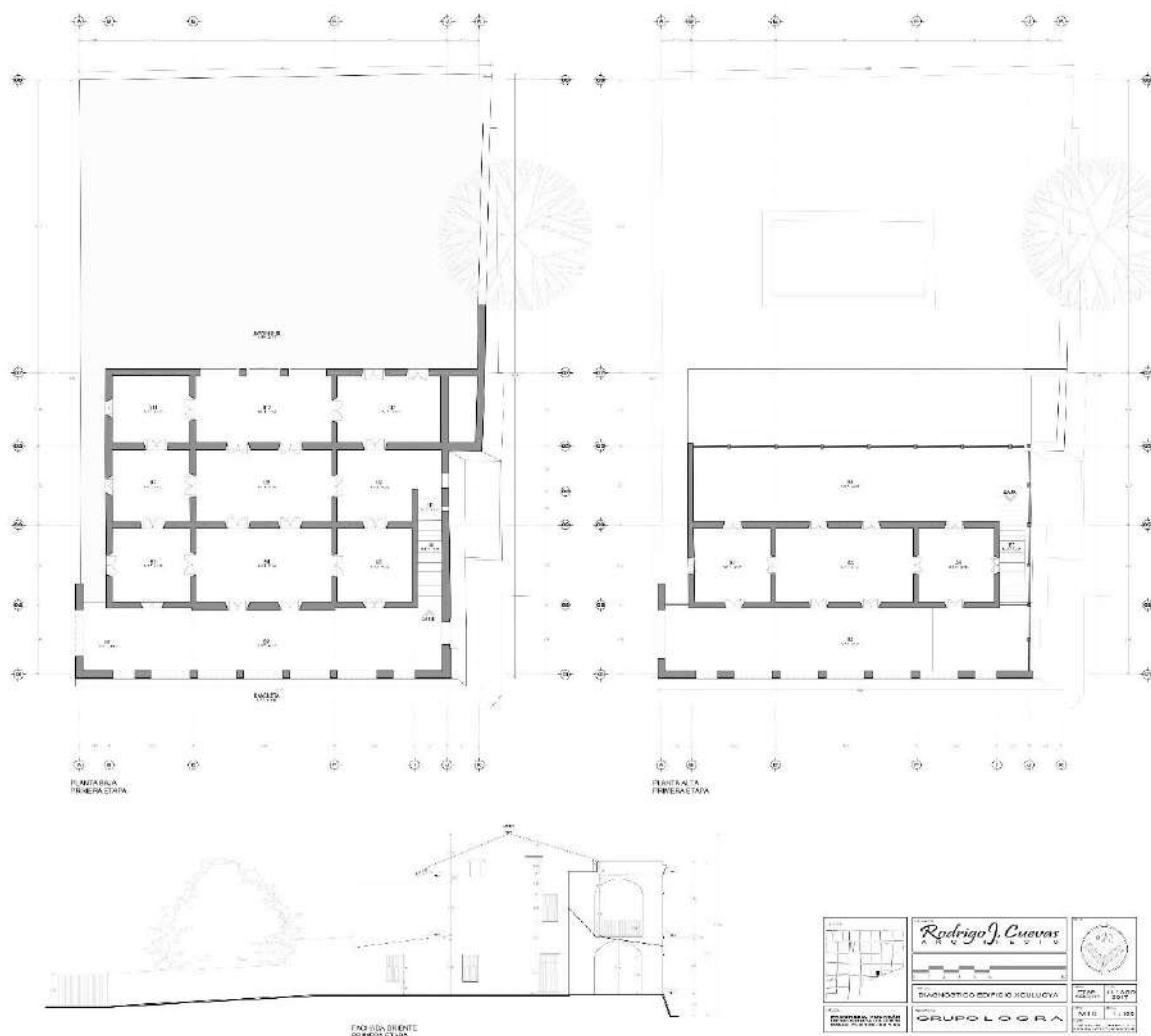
Reconstrucción de planta baja, planta alta y fachada oriente del diseño original del edificio Xculucya. Fuente: Elaboración propia.
